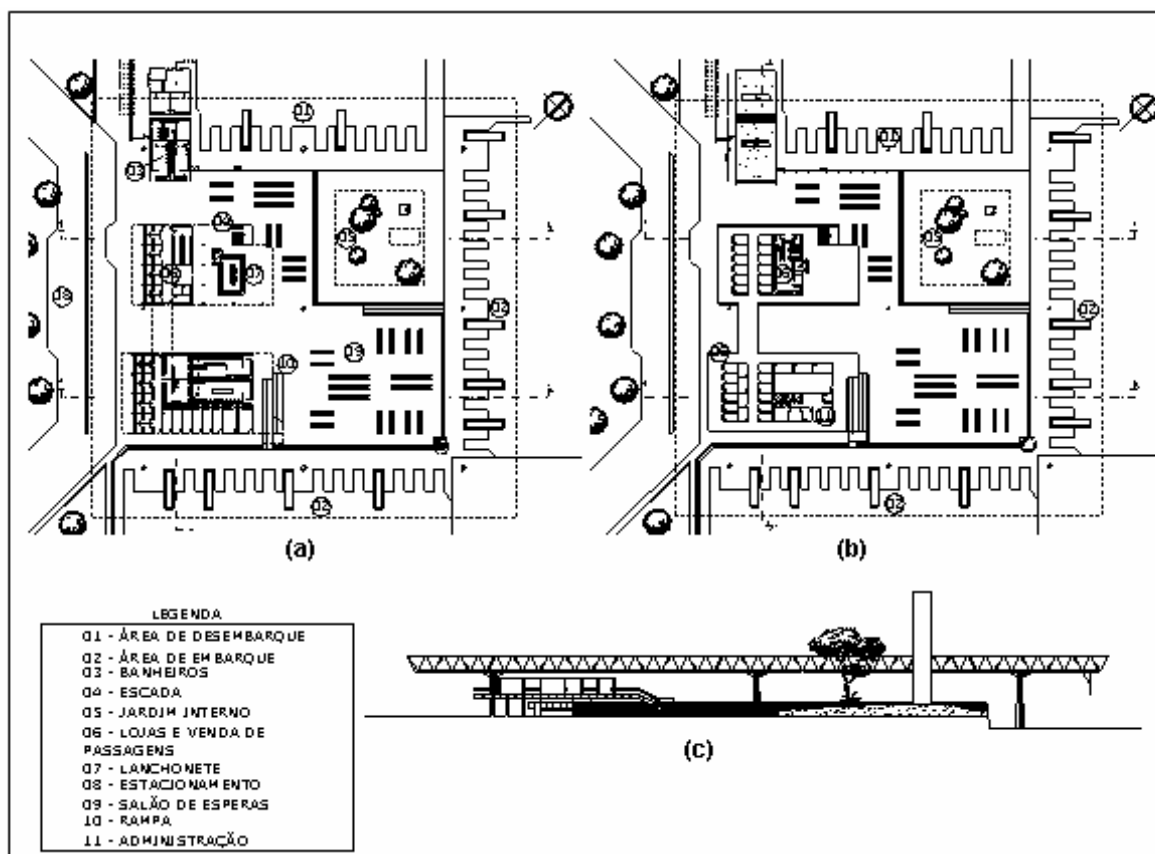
O Terminal Rodoviário de Maceió (a) Planta Baixa do Pavimento Térreo, (b) Planta Baixa do Mezanino e (c) Corte esquemático
